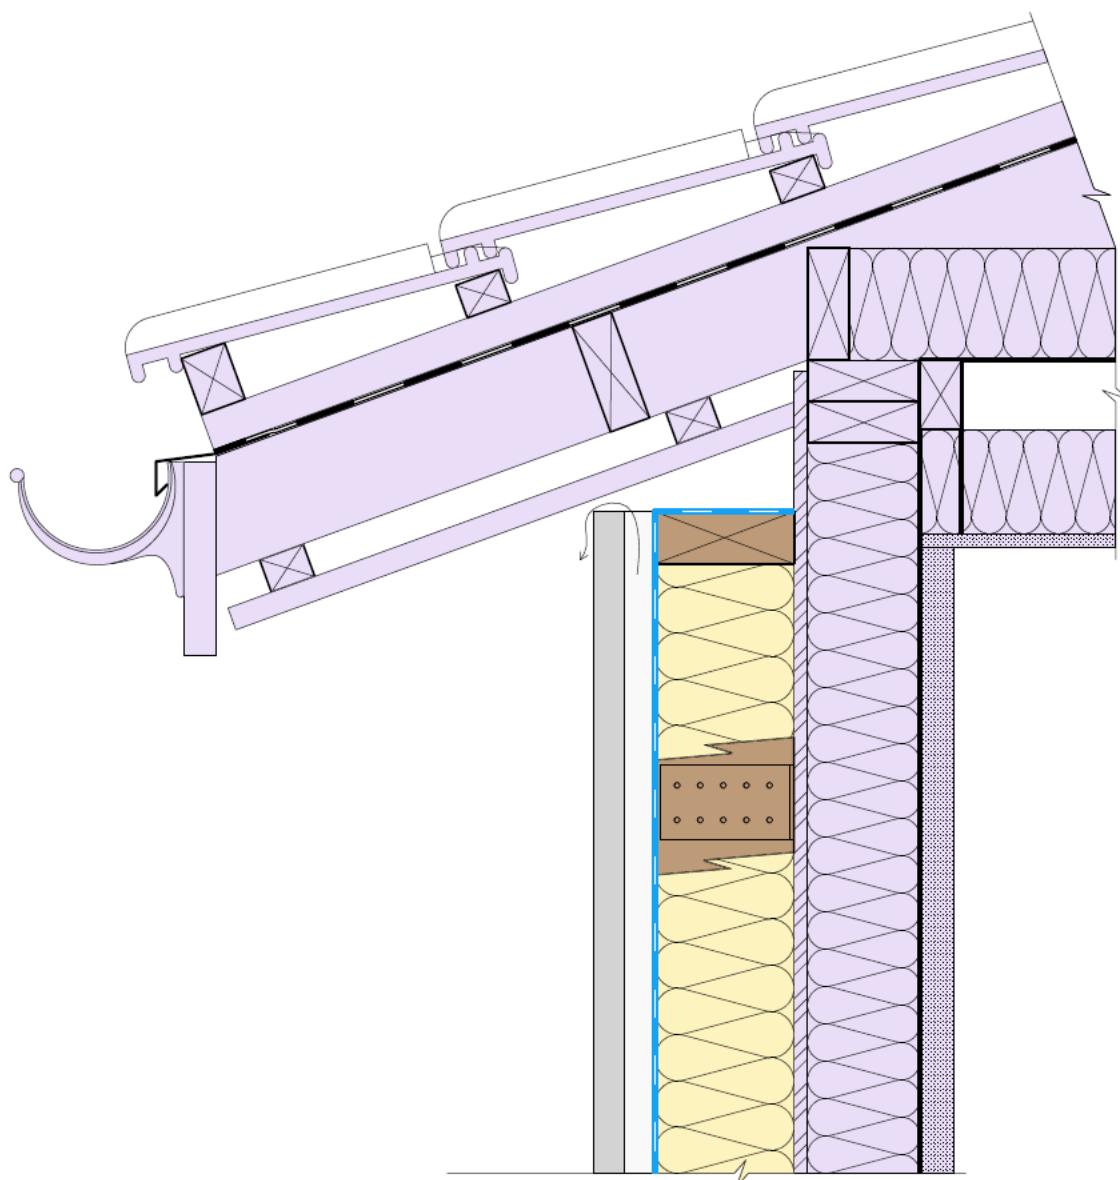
Raccordement sous débord de toiture (coupe verticale)
